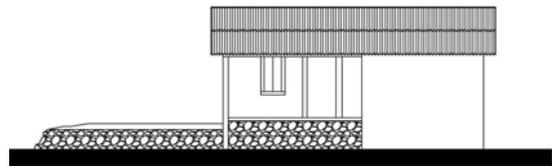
Fachada Norte (Acervo PROAU/FAU/UnB).
